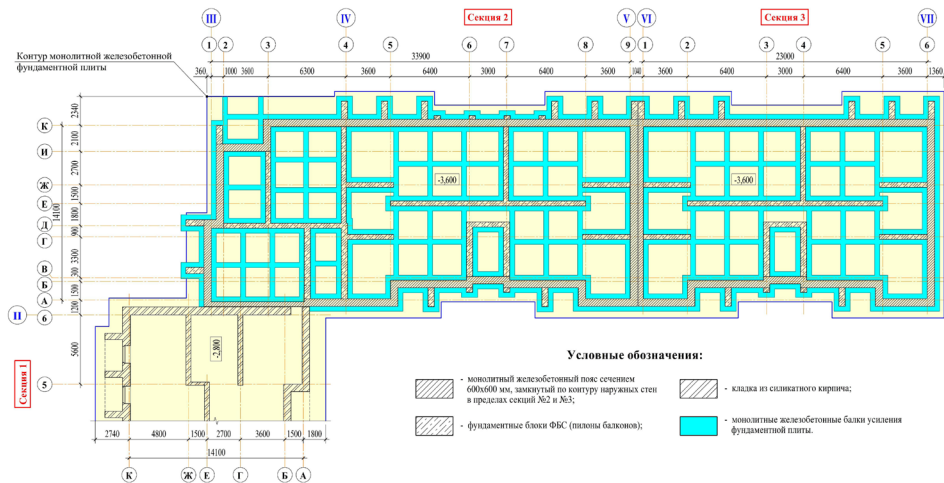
Схема конструктивного усиления фундаментной плиты секций № 2 и № 3 системой перекрестных монолитных железобетонных балок
